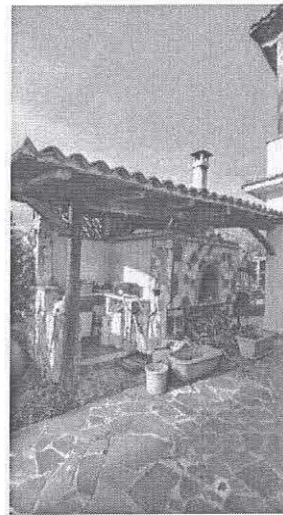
tettoia posta sul retro con forno a legna in muratura
